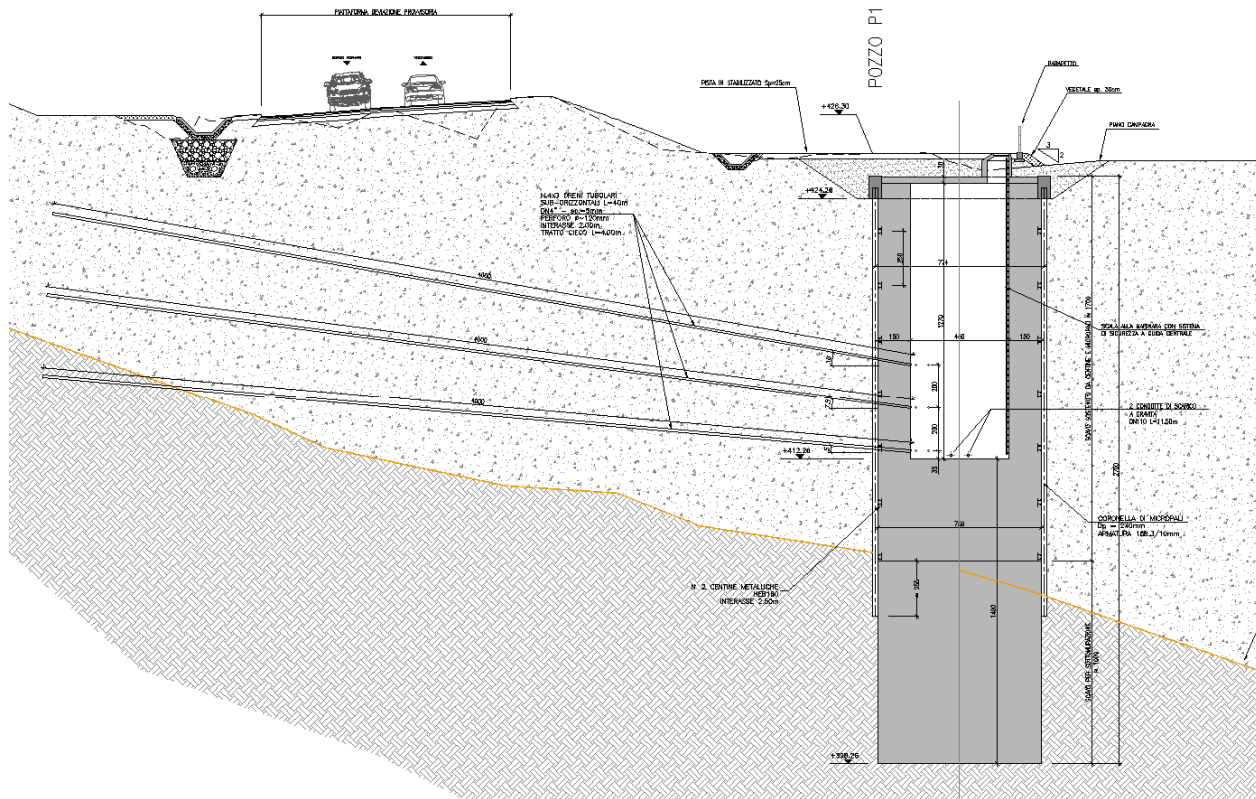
Sezione tipologica pozzi drenanti strutturali
